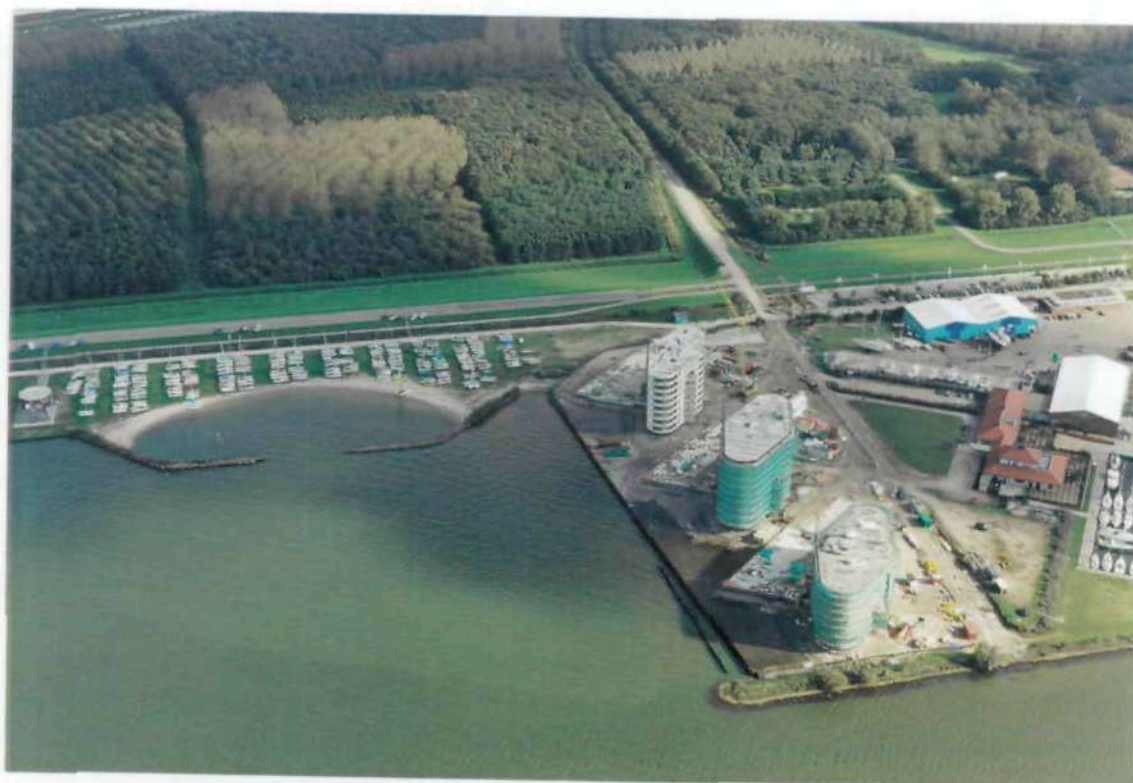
Situatie jachthaven Muiderzand west 2000 met de bouw van flatgebouwen naast één van de gerealiseerde bekken.
